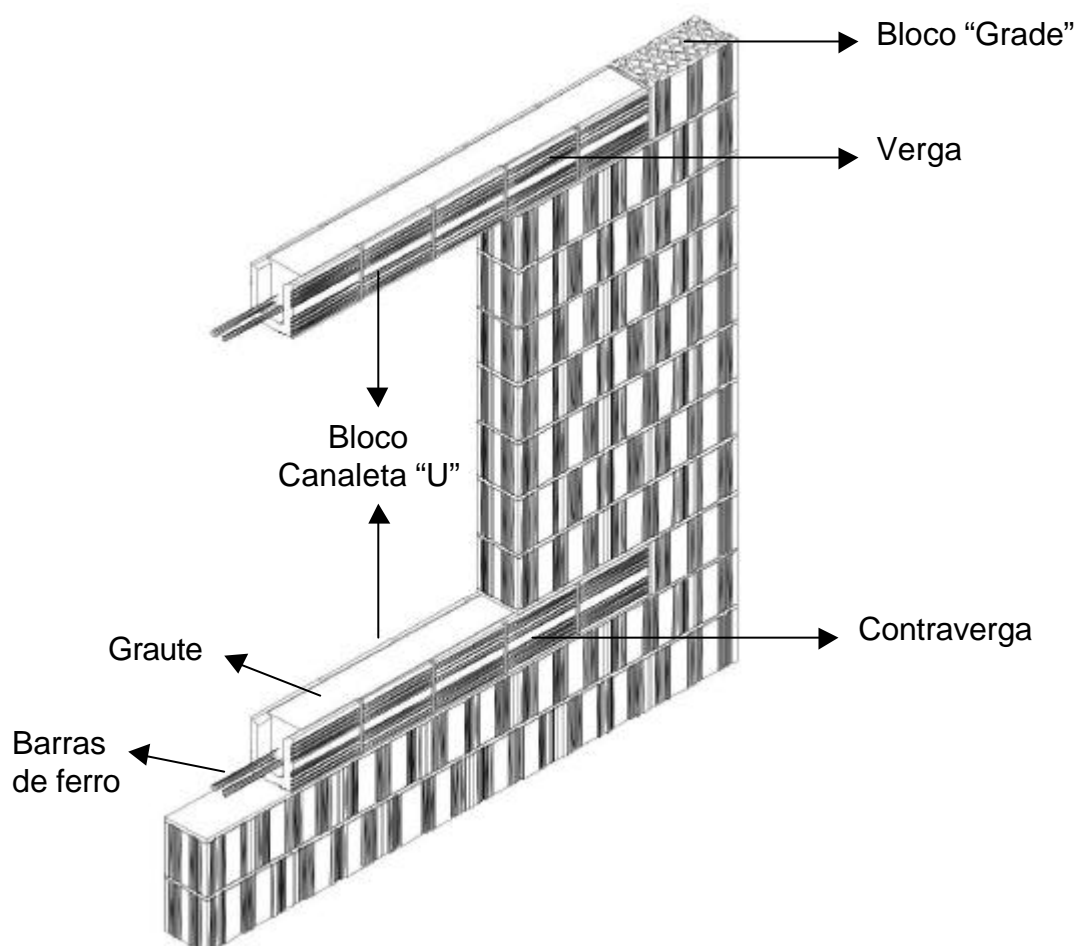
Vergas e contravergas construídas com o Bloco canaleta “U”.
